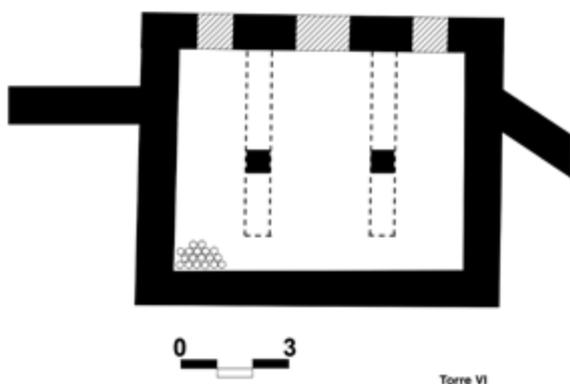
Piso intermedio de la torre VI, con la propuesta de ubicación de los pies derechos que sostendrían el forjado de la terraza. Las líneas discontinuas señalan los muros de la planta inferior.
